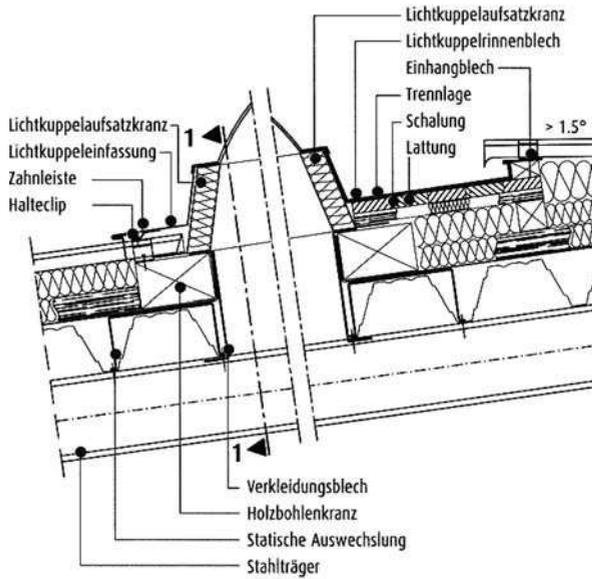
Längsschnitt durch eine Ausrahmung für den Einbau in Klemmfalzprofile aus Stahl
